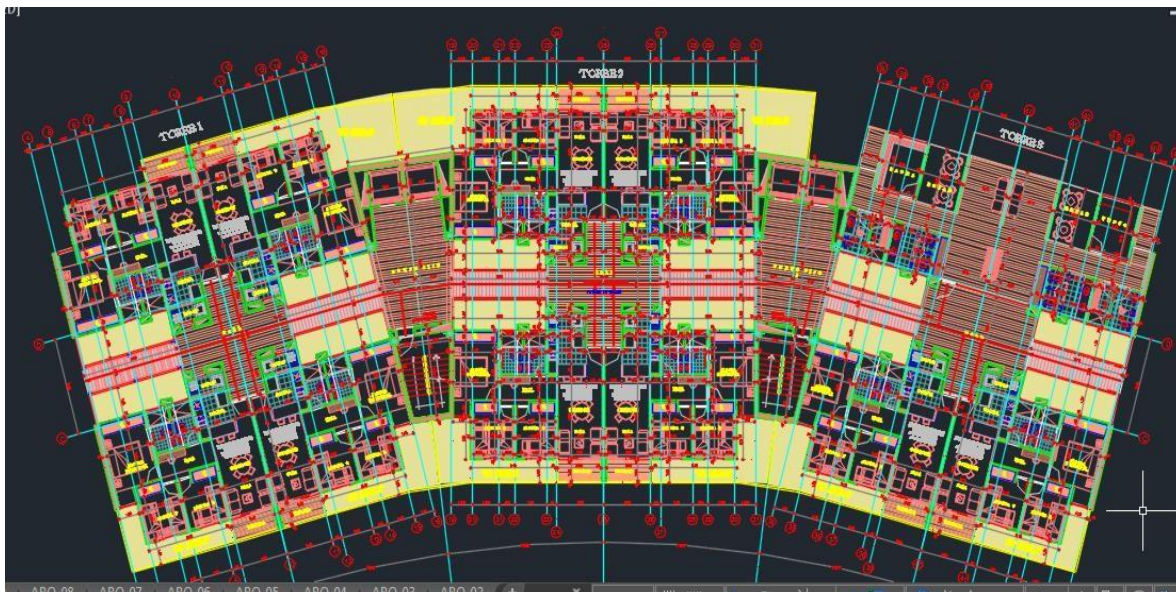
Plano arquitectónico, planta tipo de apartamento.
